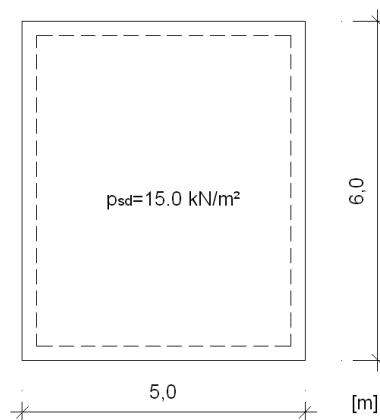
Geometria e carga para a laje simplesmente apoiada
